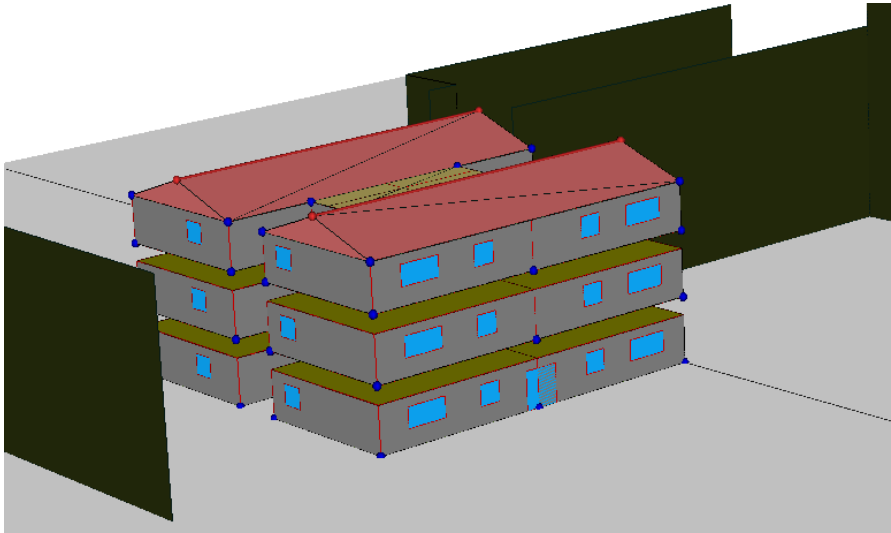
Tipología de bloque en H (Bloque 5, Plaza de Oriente). Fuente: *Elaboración propia.
